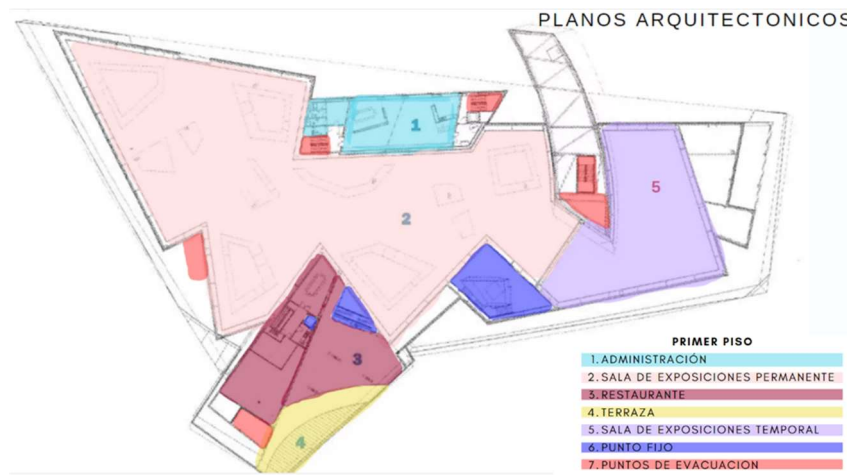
Zonificación. planta baja Museo Imperial de Guerra-Manchester
